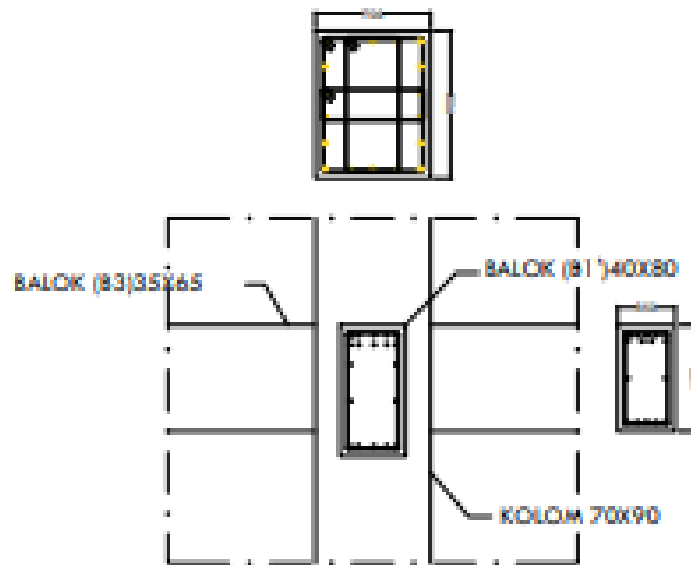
Detail Rencana Balok Lati Elv. + 9.36
